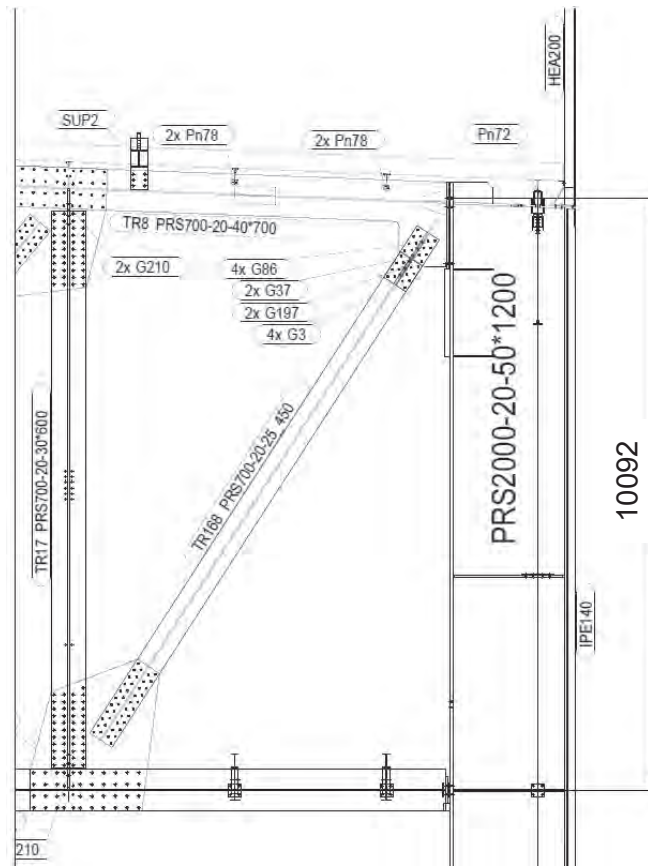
détail liaison poutre treillis sur poteau PRS2000 (cotes en mm)
